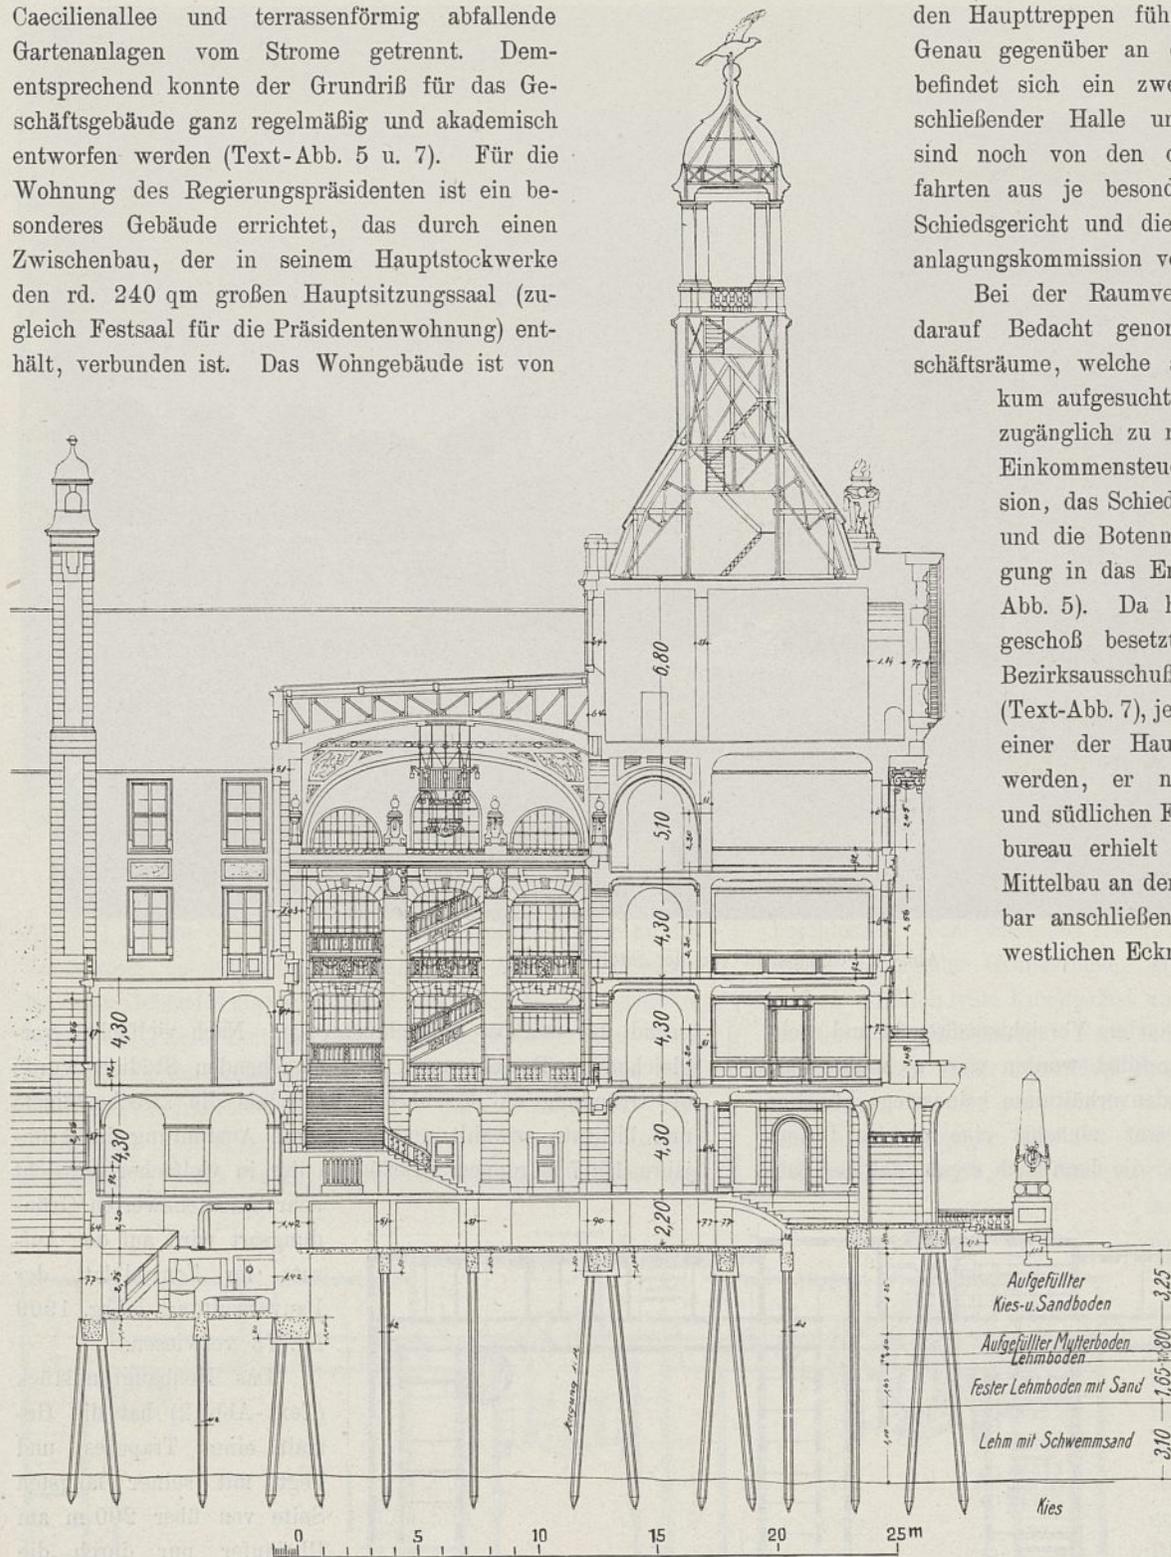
Schnitt durch Haupteingang und Haupttreppe.
